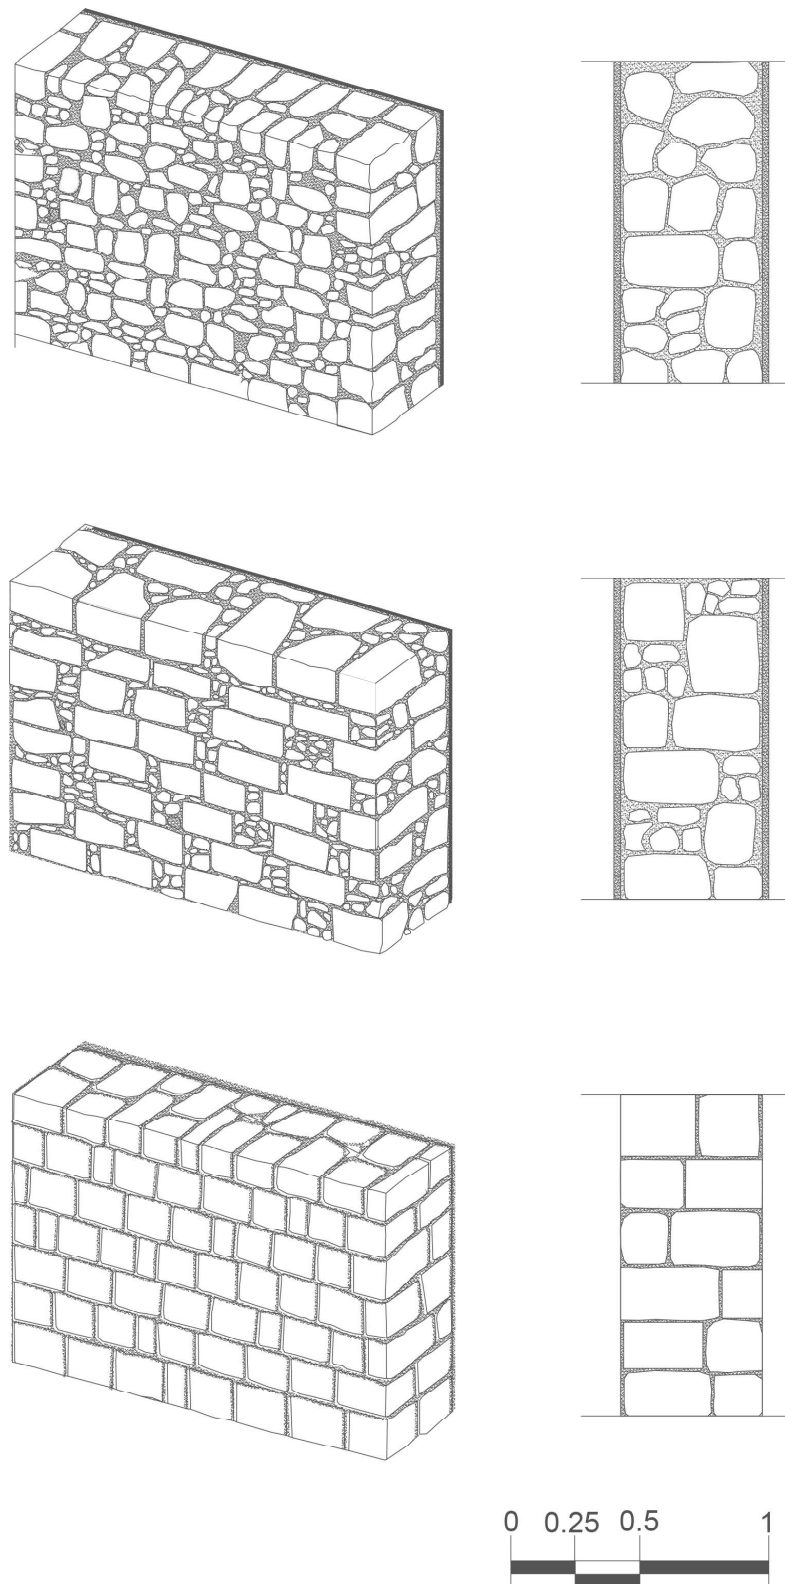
Les trois grandes types de murs : a) en haut, le mur avec pierres de réemploi ; b) au centre, le mur mixte avec pierres nouvelles et de réemploi ; c) en bas, le mur avec pierres nouvelles
